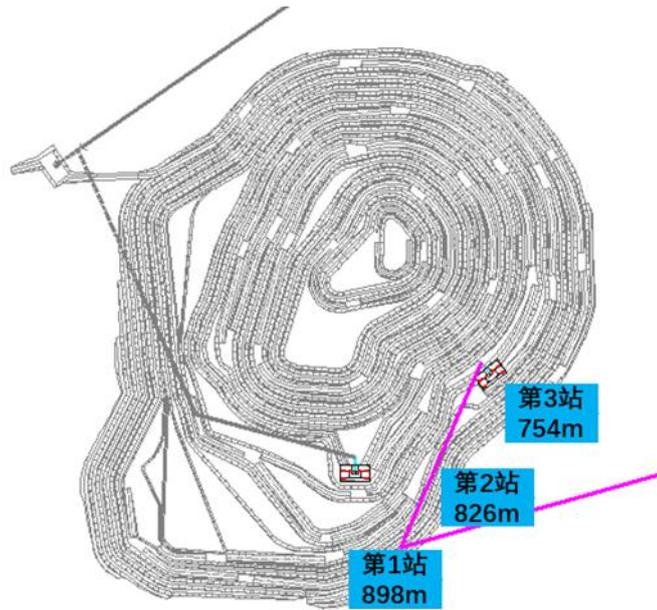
汽车-半移动破碎站-胶带-联合运输平面图
